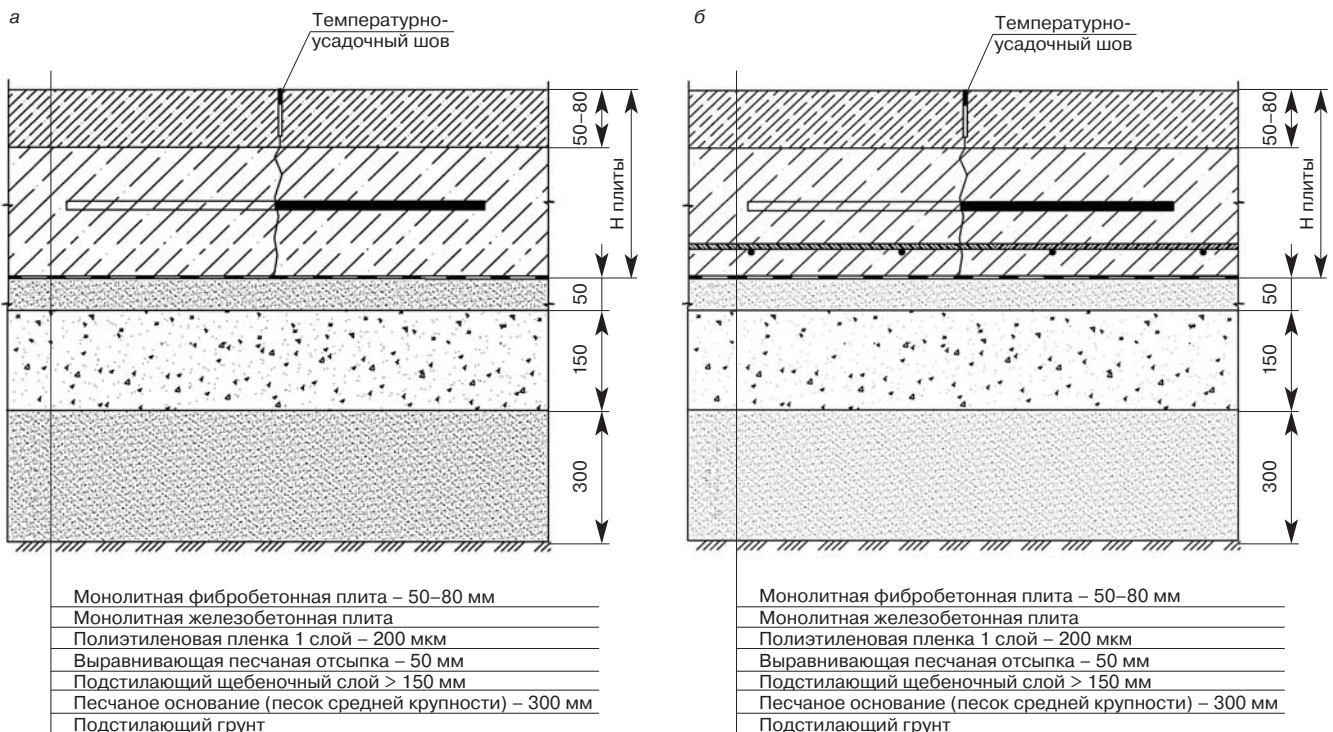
Конструкция комбинированной двухслойной бетонной плиты пола производственного здания: а, вариант 1 – двухслойная комбинированная бетонная плита с усиленным фибробетонным слоем; б, вариант 2 – двухслойная комбинированная железобетонная плита с усиленным фибробетонным слоем
